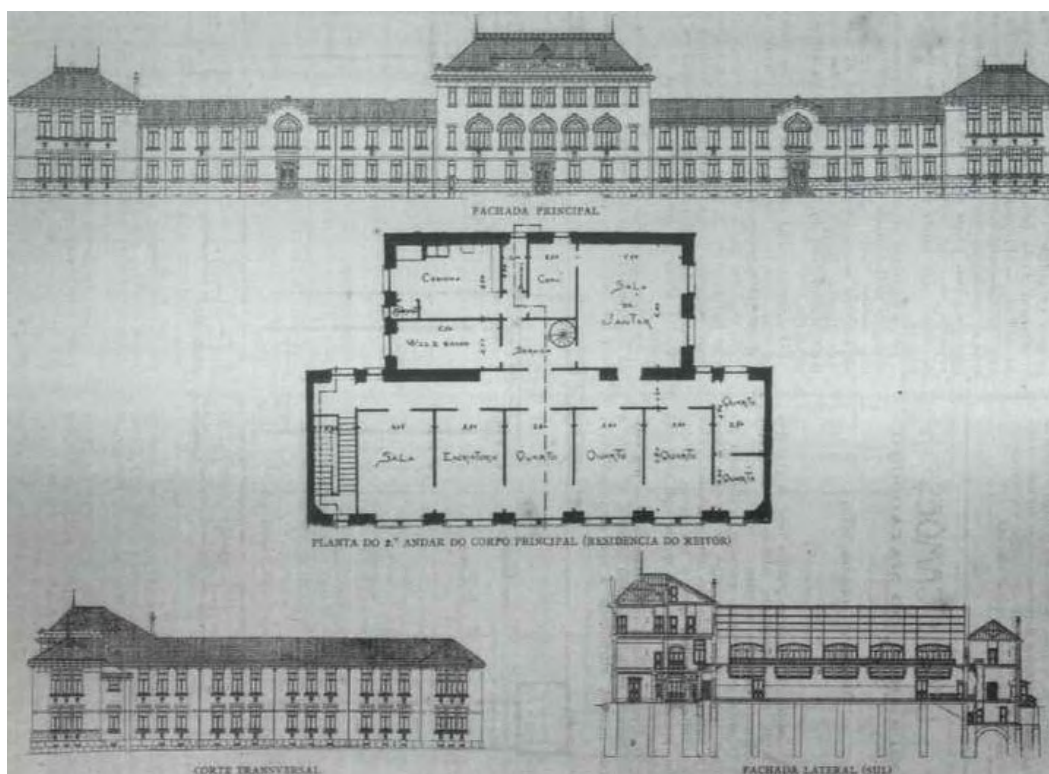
Planta original do sótão, fachadas principal e sul e corte transversal
